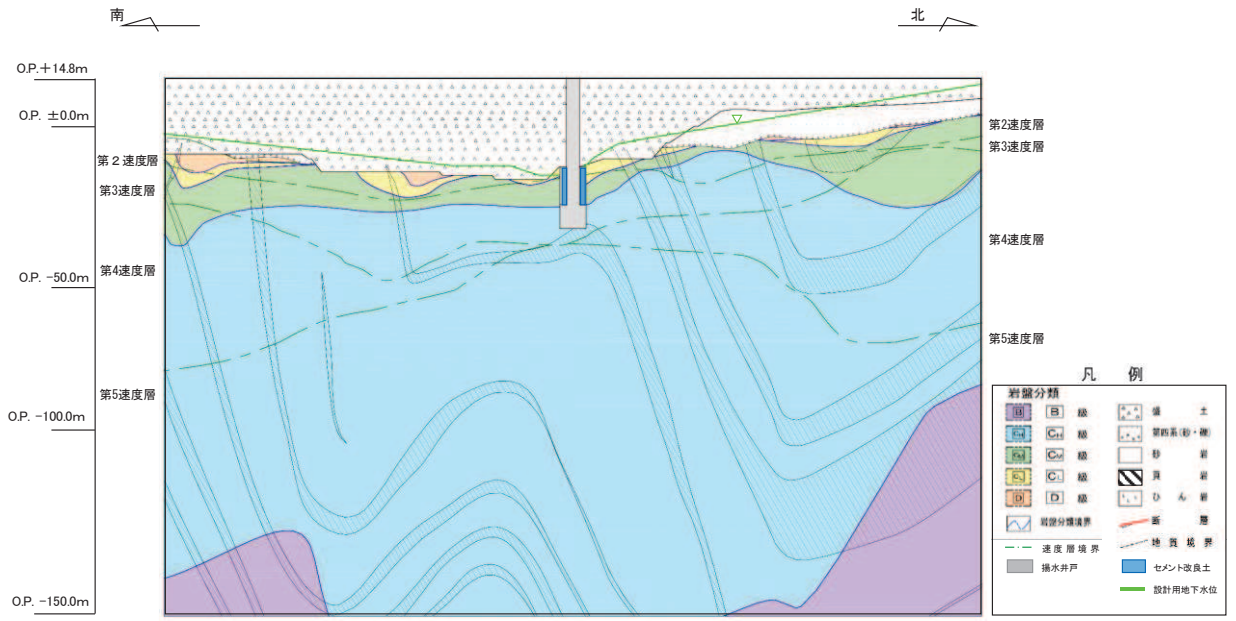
(3) No.3 揚水井戸 評価対象断面図 (C' -C 断面)
